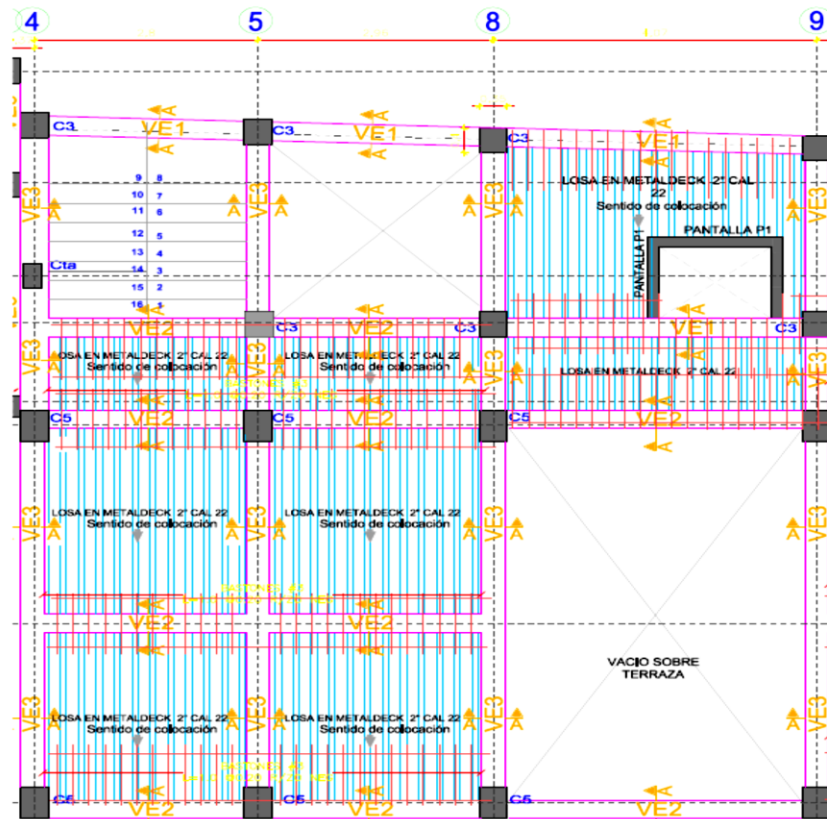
PLANTA ENTREPISO DEL NIVEL 3 DEL BLOQUE 1 (+6,00 MTS).
